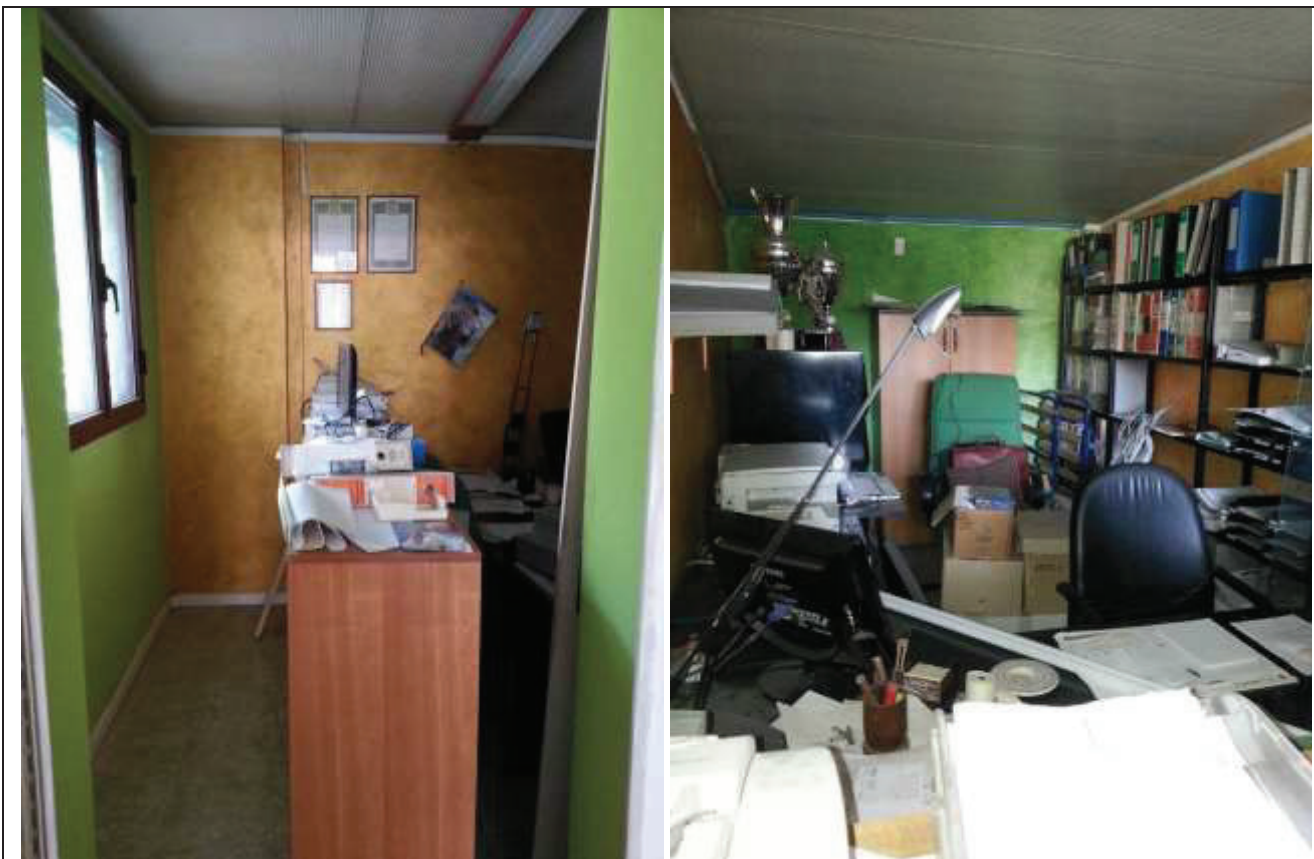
Sub. 11 (ex garage) attualmente utilizzato come locale ufficio (diffinità catastale).
